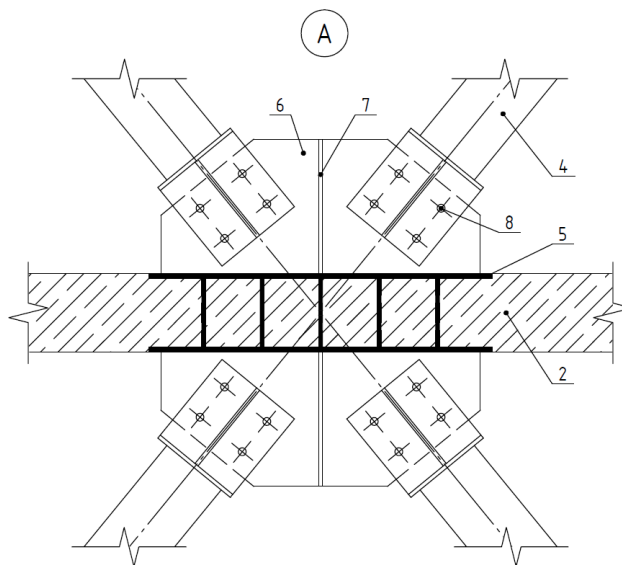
Узел крепления элементов связей к плите перекрытия: 2 – плита перекрытия; 4 – элемент связи; 5 – закладная деталь; 6 – фасонка; 7 – ребро; 8 – болты
